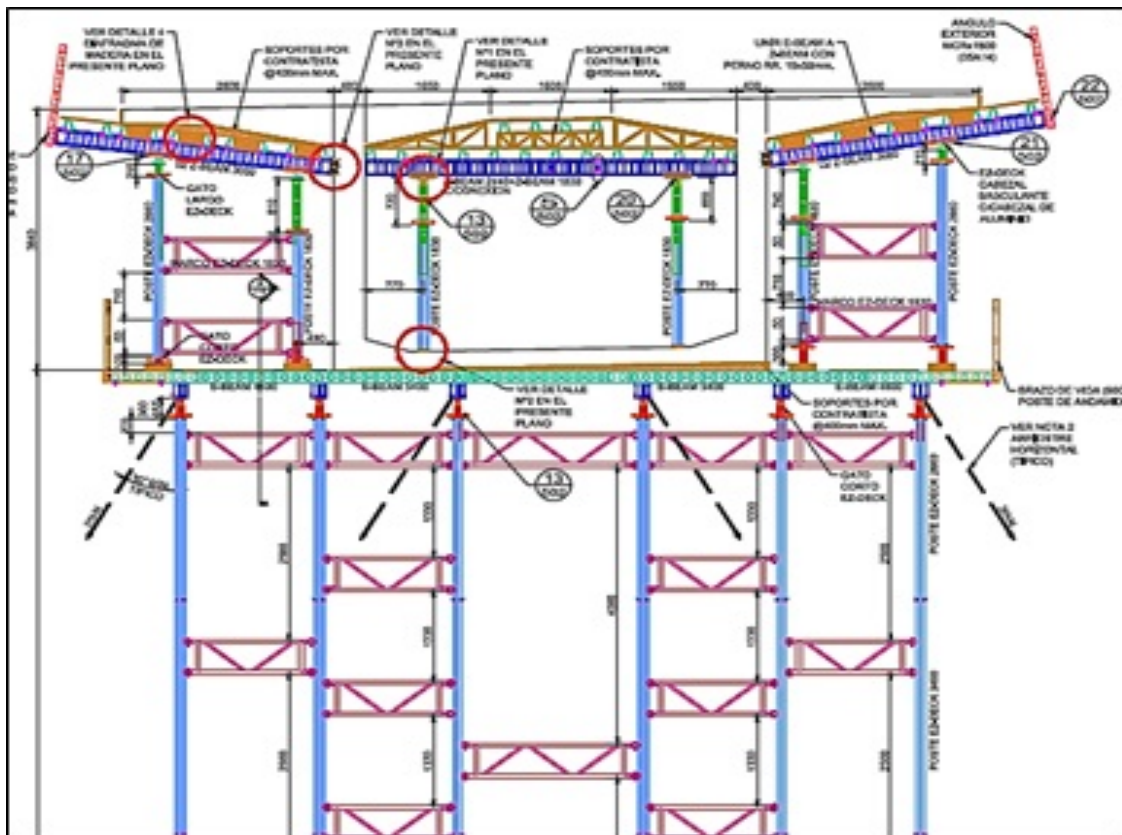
Sec. Trans. de Cimbra y encofrado de la losa superior. (Fuente: EFCO)
